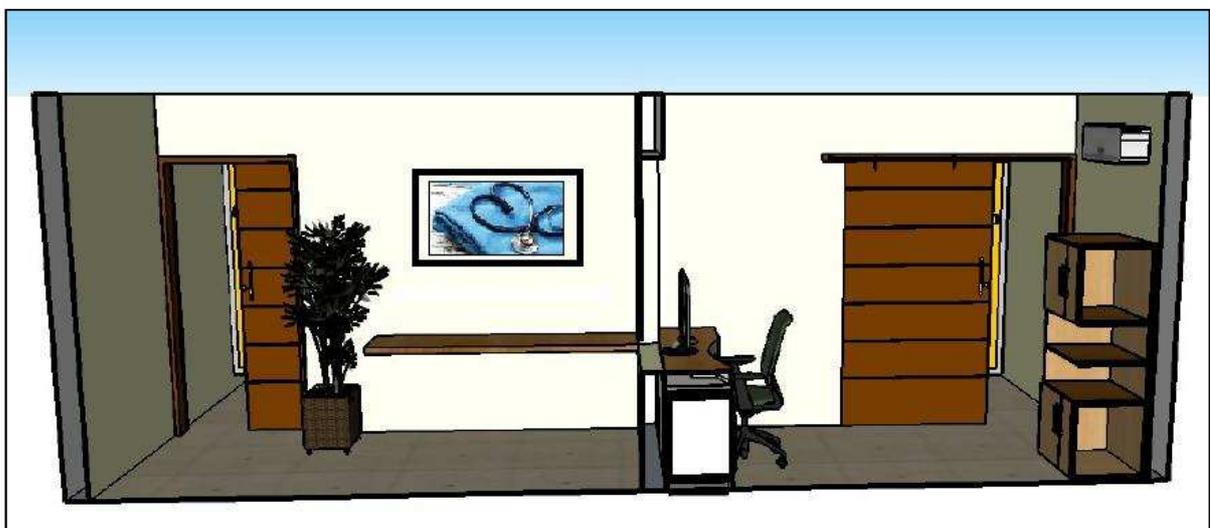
Planta Baixa: Proposta de reestruturação do arquivo
